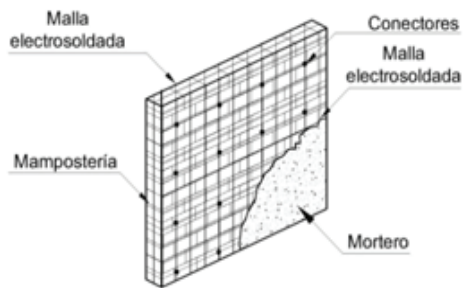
Sistema de mampostería revestida con malla electro-soldada y recubierta con hormigón ó mortero
